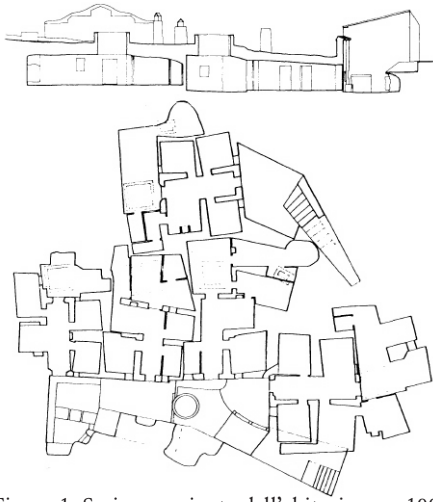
Sezione e pianta dell'abitazione n 100, "Cuevas de la Torre", Paterna (Aranda Navarro, F. Materia prima. Arquitectura subterránea excavada en el levante español. Pag.34)
